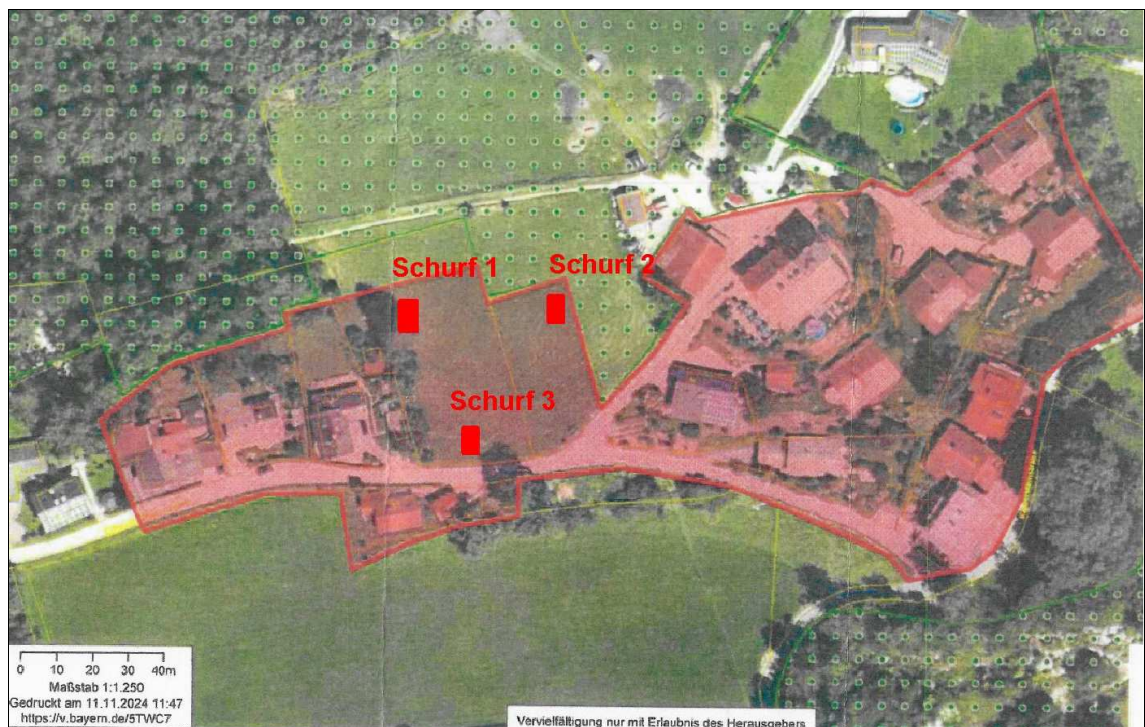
Lageplan mit den Bodenaufschlüssen Schurf 1 bis Schurf 3
